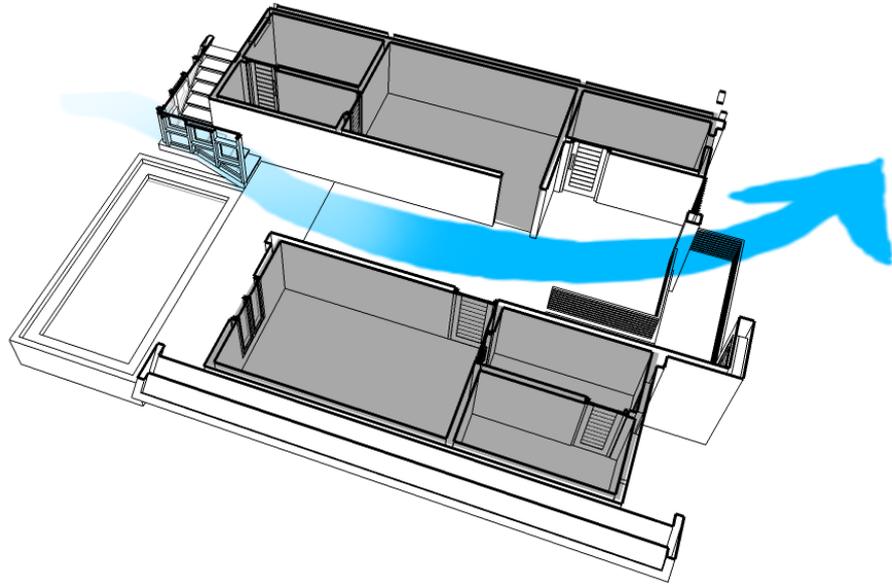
Menunjukkan Desain Bangunan dengan Muka Lantai yang dinaikkan dan selubung bangunan yang dilapisi kisi-kisi
